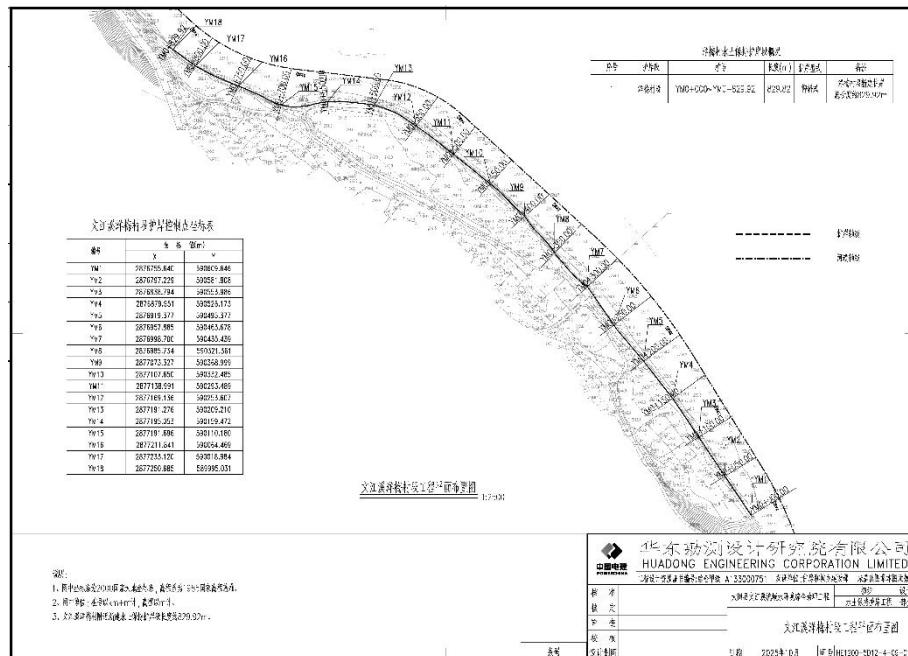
文江溪洋梅村段水土保持护岸平面布置图
